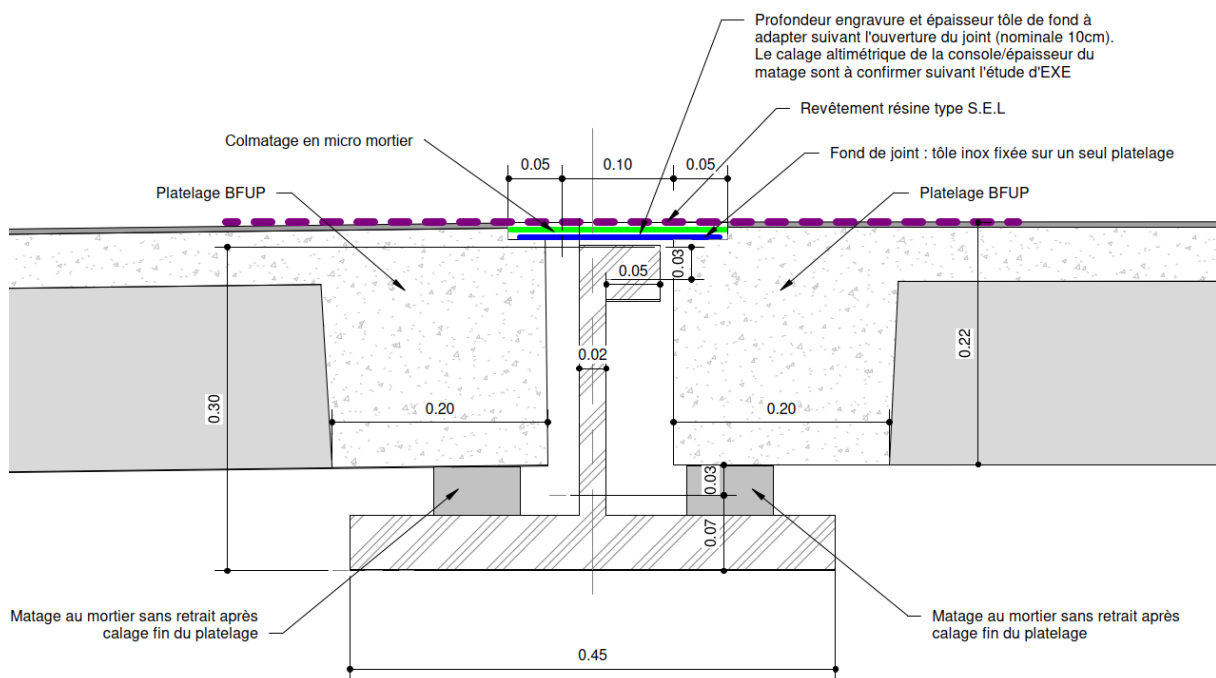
Joint entre platelages pour la console PRS sur passe navigable
